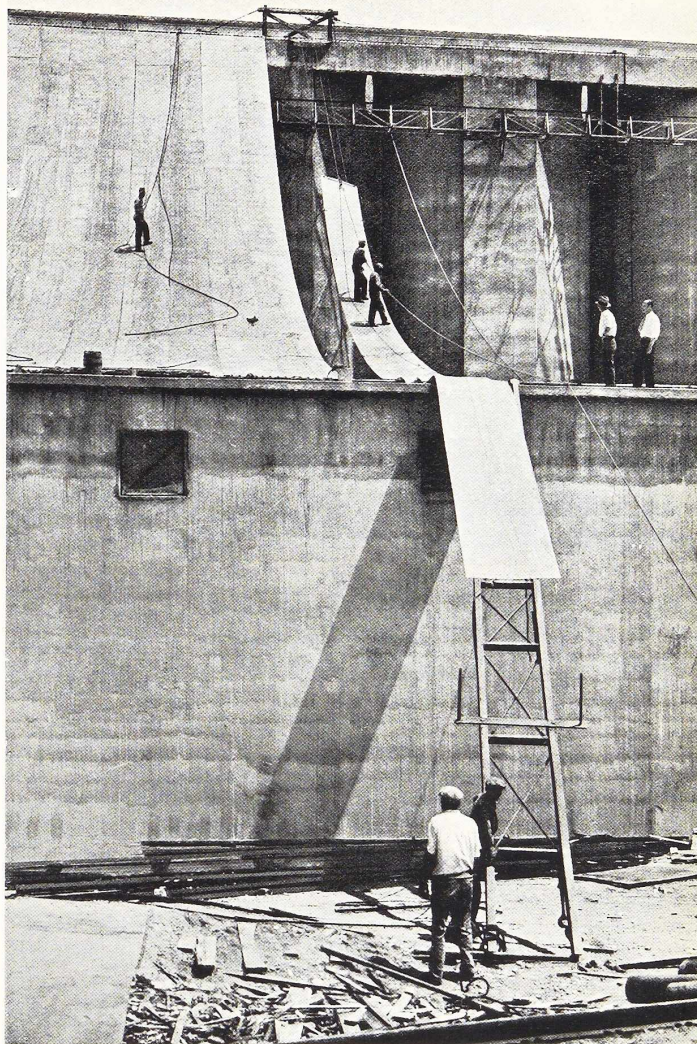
Mise en place d'une bande de tôle, dont les éléments ont été préalablement assemblés par soudure. Le treuil de hissage est installé au sol, un châssis en bois installé au faite de la toiture, supporte la poulie de renvoi du câble tracteur.
